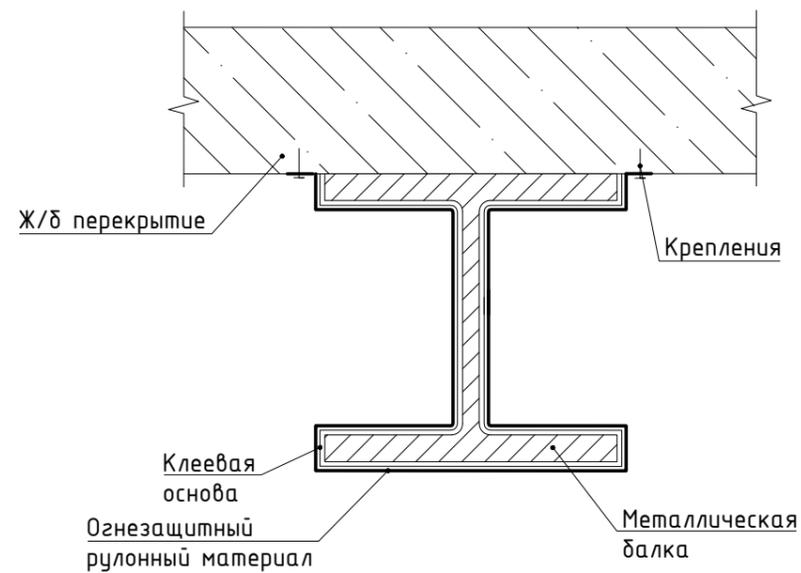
Огнезащита рулонными материалами металлической балки, примыкающей к ж/б перекрытию
